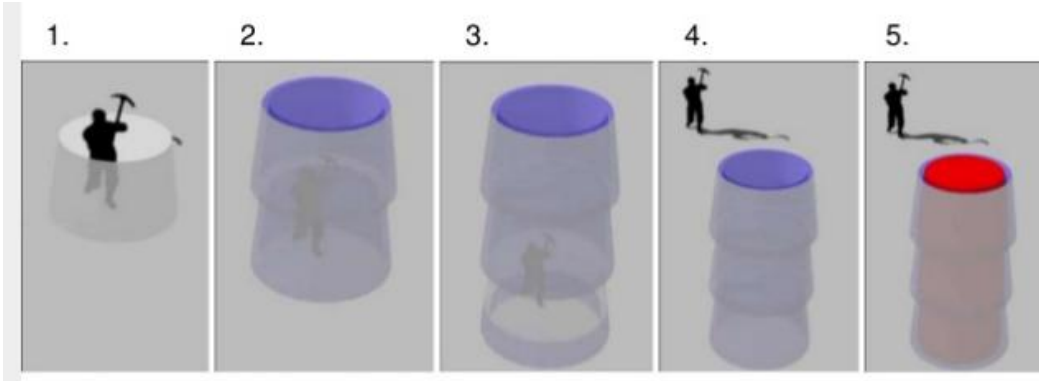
PROCESO CONSTRUCTIVO DE ANILLOS DEL CAISSON
